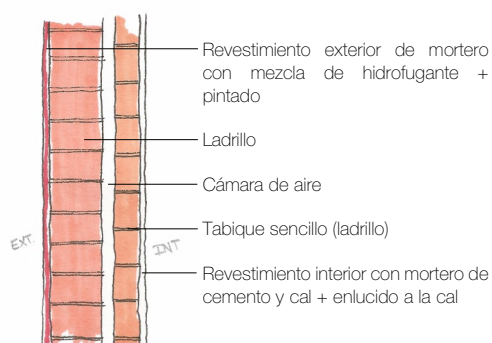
Detalle en sección de la pared de fachada (autoría propia).
